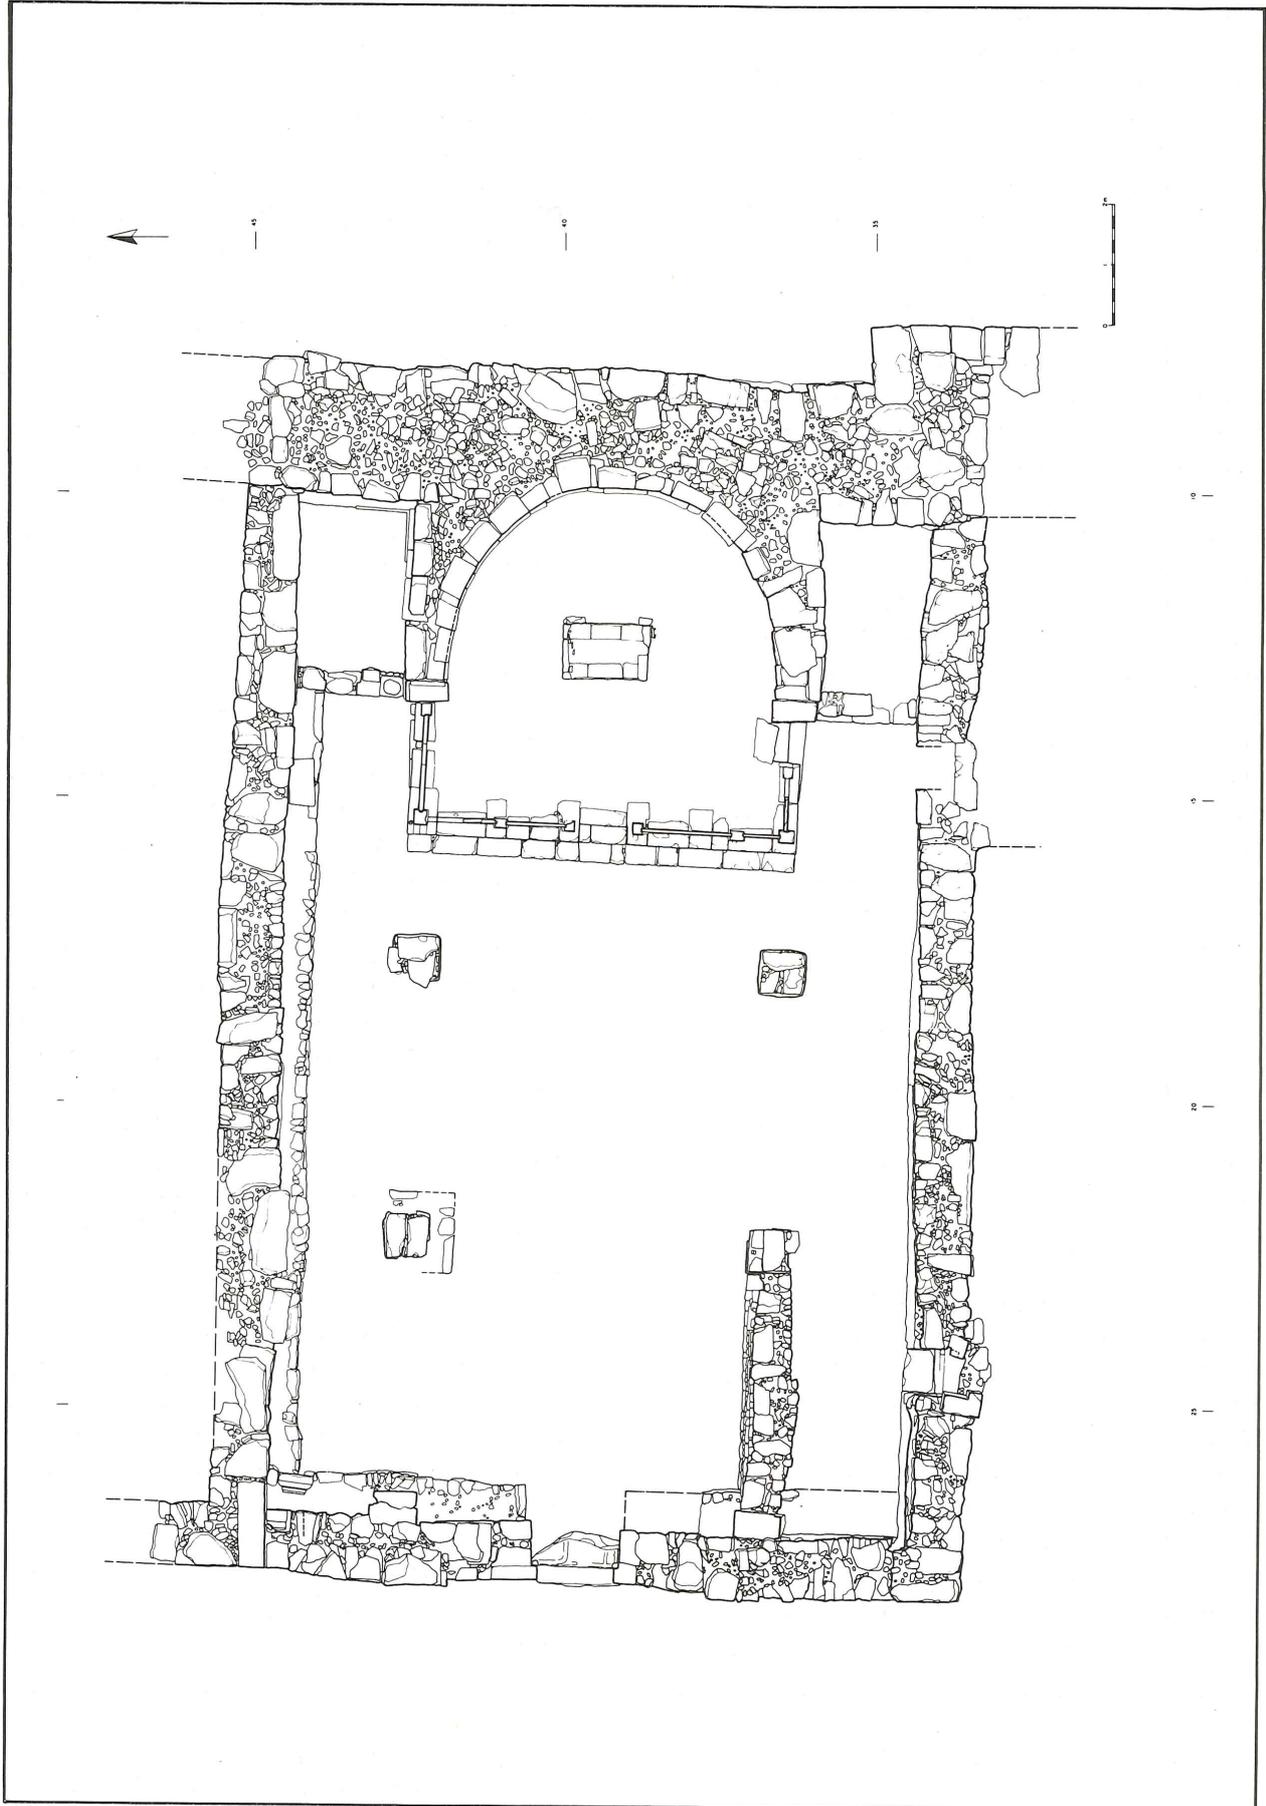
Umm er-Raşâs. Plan au pierre-à-pierre de l'église sud avec l'arcade effondrée.
